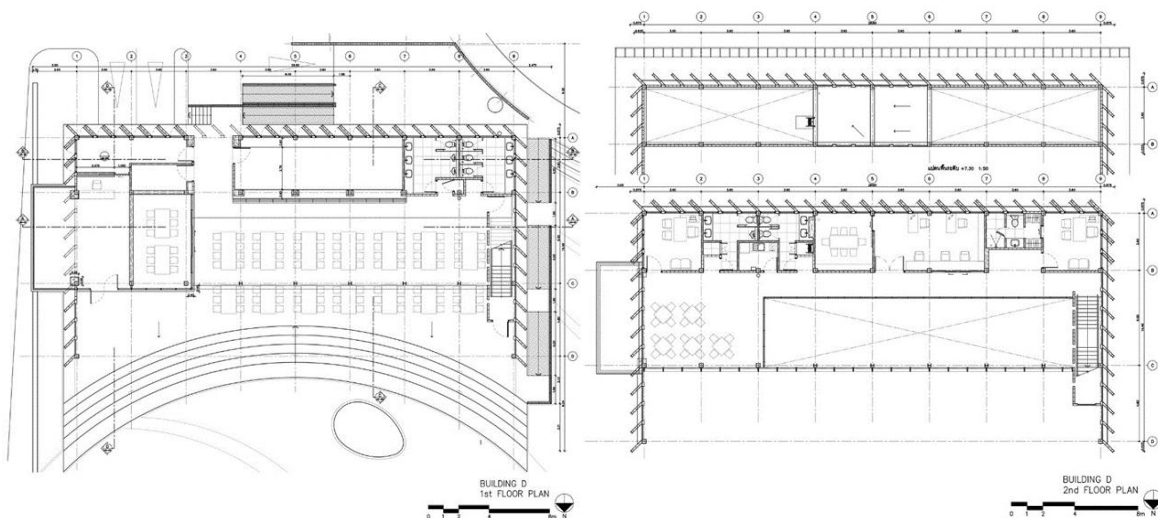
Planta baixa, térreo e 1º andar do Bloco D
